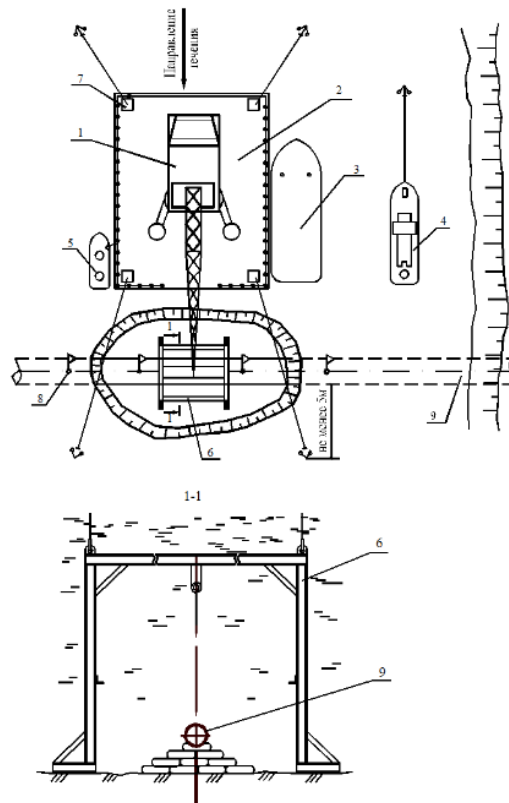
Схема расстановки для демонтажных работ в период открытого русла на несудоходных реках [3]
